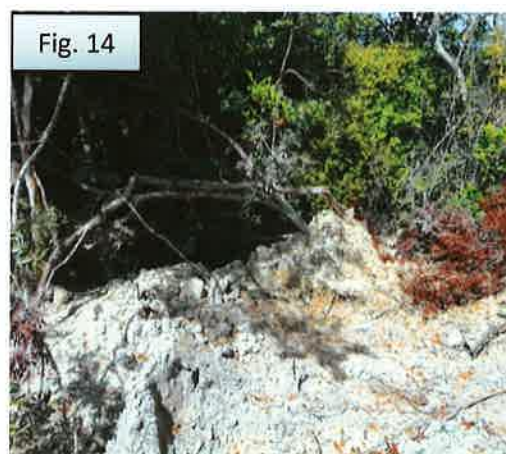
hasta la 16: Se observa los trabajos realizados y las afectaciones sobre el bosque de galería de la quebrada Sin Nombre, para la construcción de la PTAR. Igualmente se observa la tubería de descarga instalada, con salida a un drenaje pluvial.
